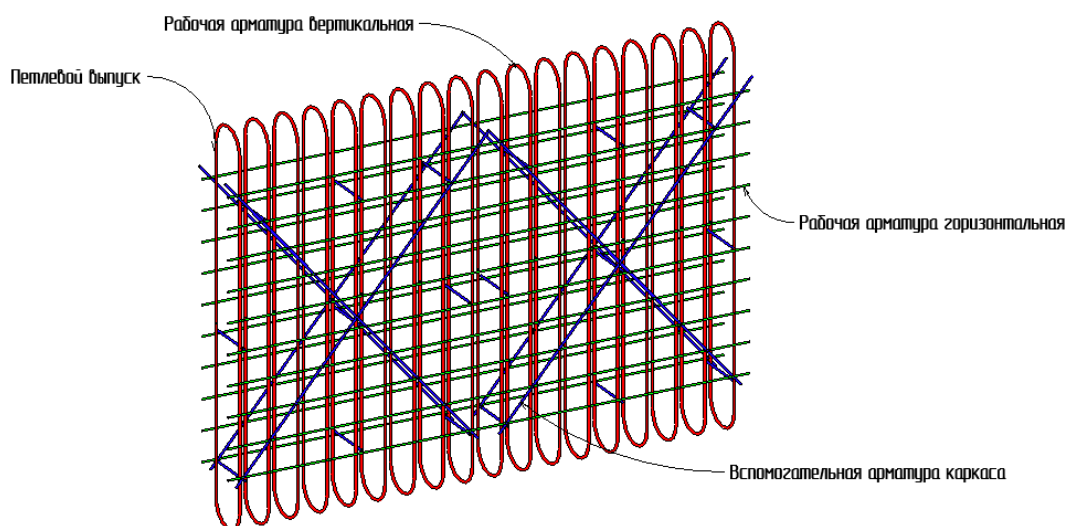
Схема арматурного каркаса с петлевыми выпусками
